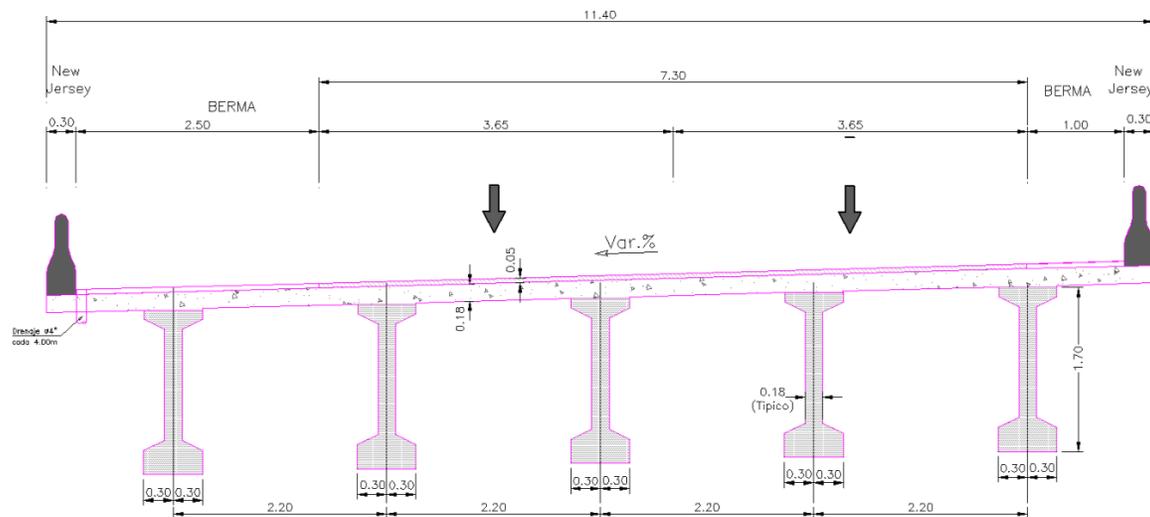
Elevación típica de los puentes de vigas postensadas de dos luces tramo 1
